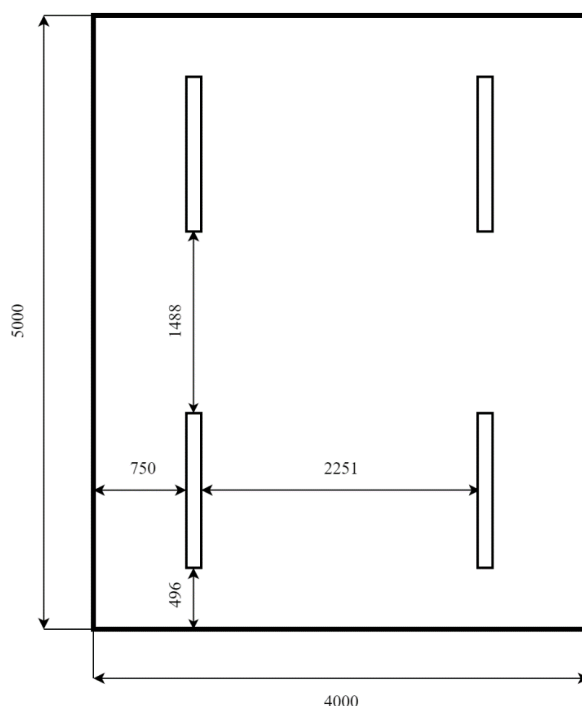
План помещения и размещения светильников со светодиодными лентами
